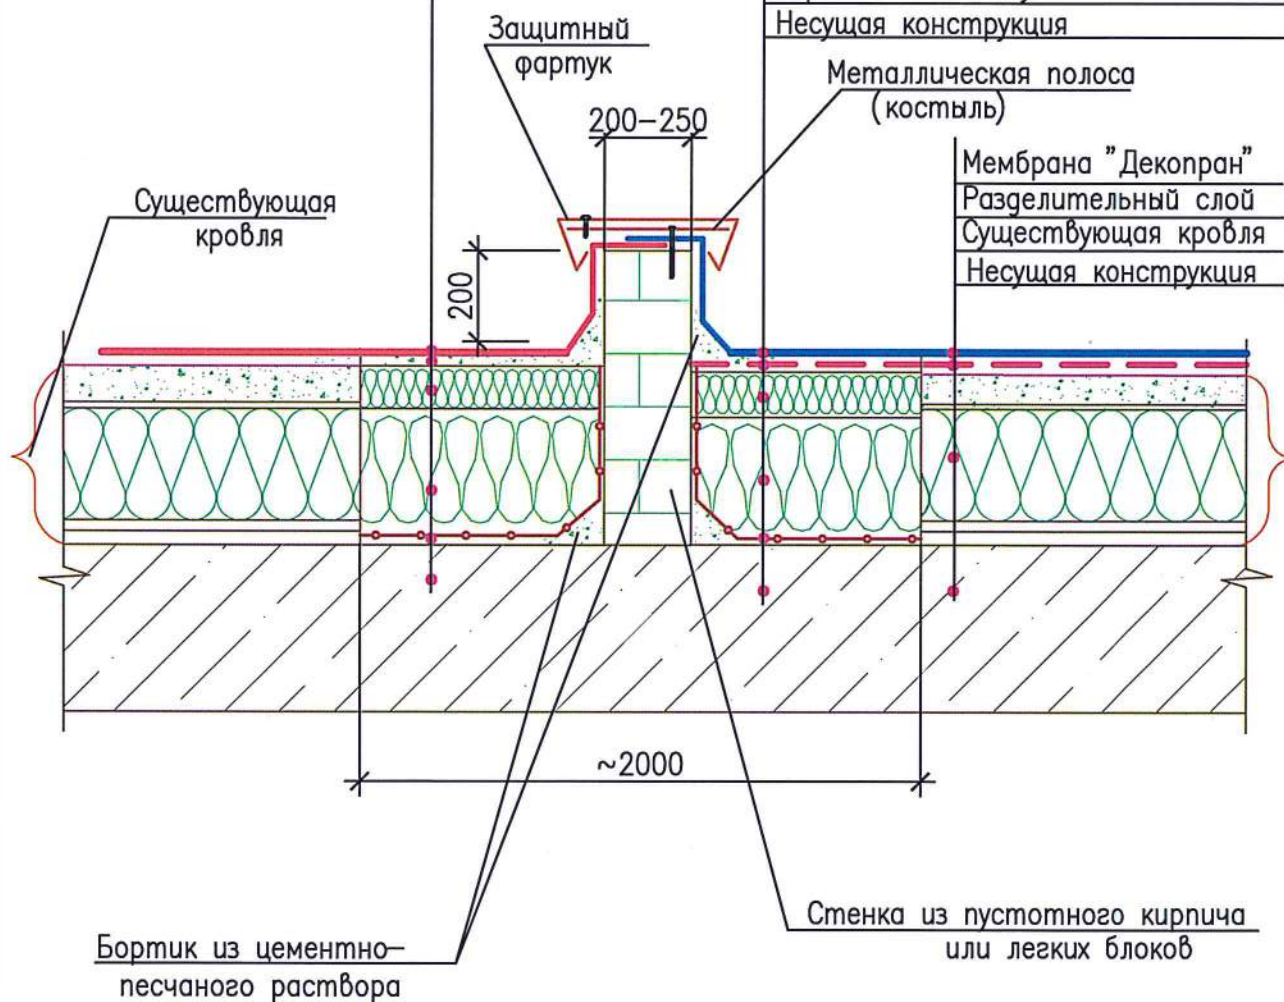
Конструктивное решение ремонта битумной рулонной кровли (переход со старой битумной кровли на кровлю из мембраны "Декопран")
